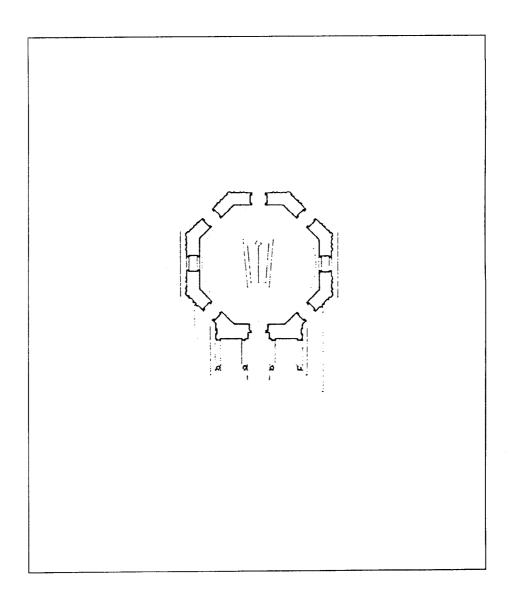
مسقط أفقي لتربة شاهزاده محمد بإستانبول (عن : اصلان ابا) .
